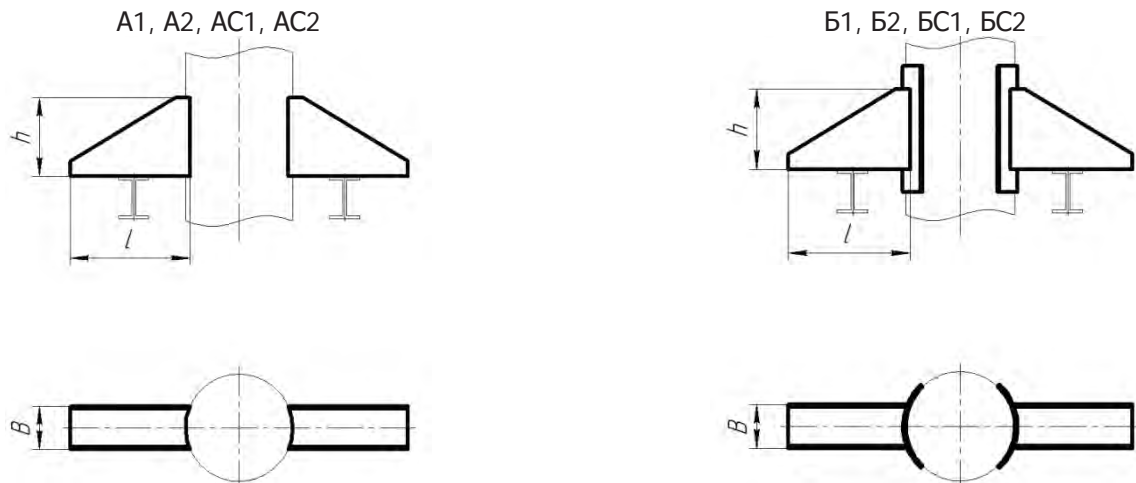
Опоры вертикальных трубопроводов (ВП)
